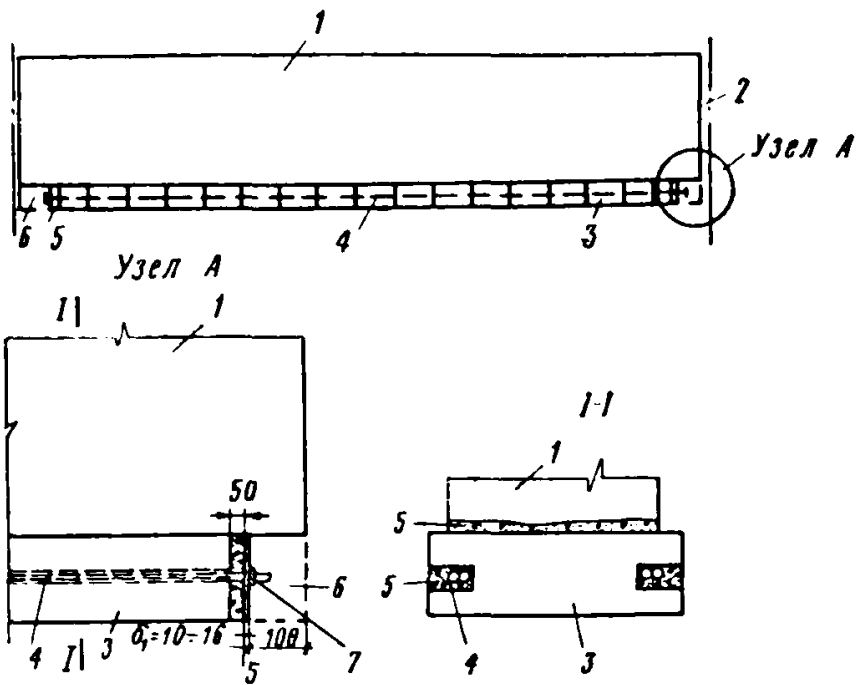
Схема усиления ленточного фундамента железобетонными подушками с затяжками
